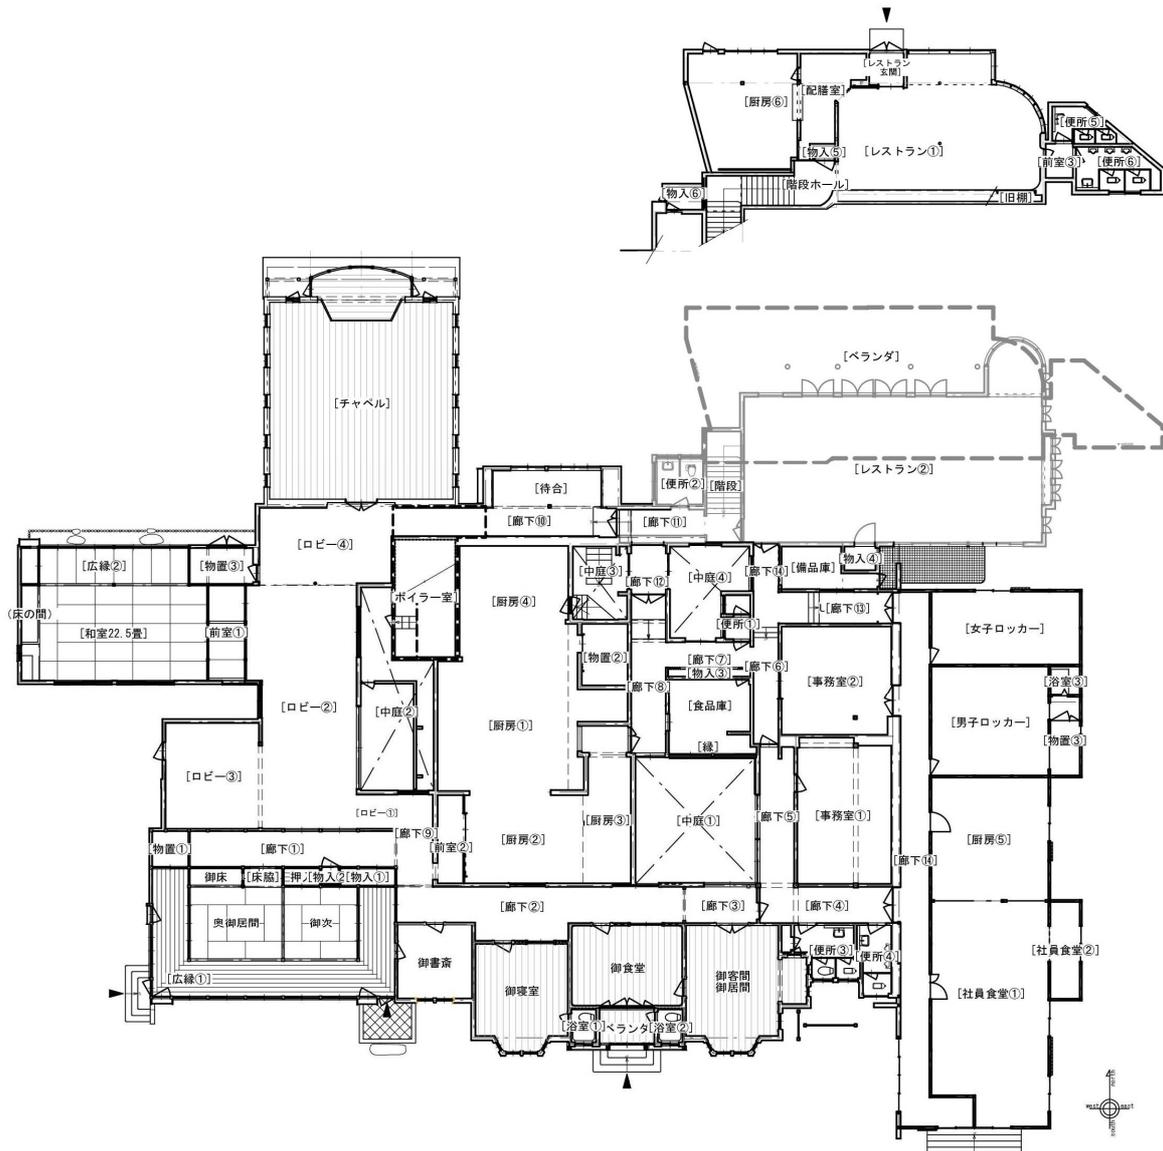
旧滄浪閣（伊藤博文邸跡・旧李王家別邸）平面図
